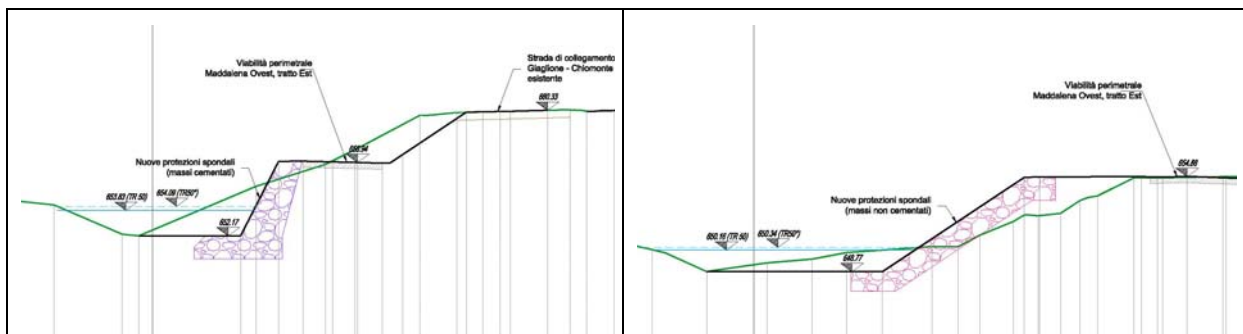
Torrente Clarea – sezione 14 (a sinistra) e sezione 18
